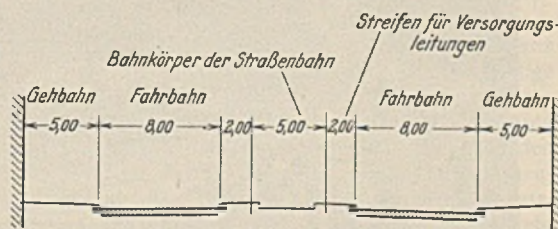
Ausfallstraße mit eigenem Bahnkörper der Straßenbahn, Querschnitt.
